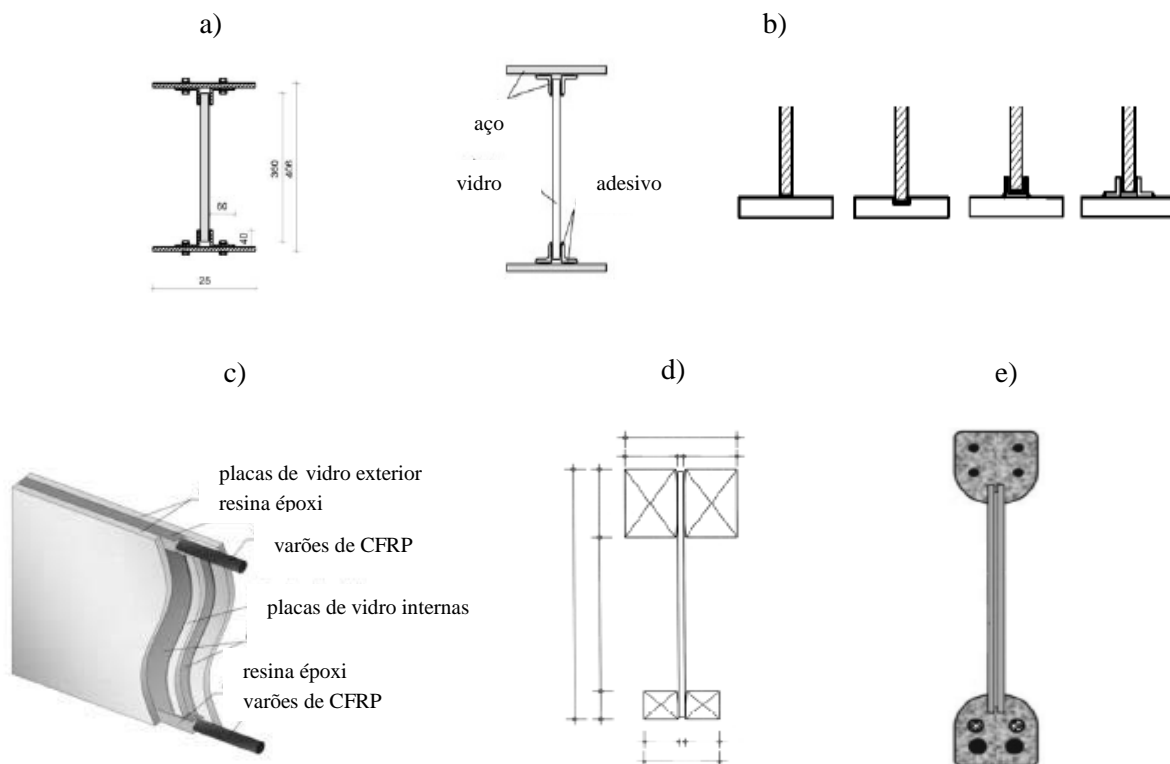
(a) Secção transversal da viga mista vidro-aço; (b) Secção transversal da viga mista vidro-aço com diferentes juntas; (c) Viga mista vidro-CFRP; (d) Secção transversal viga mista vidro-madeira; (e) Secção transversal Viga mista vidro-betão-armado (adaptado Louter, 2011).
